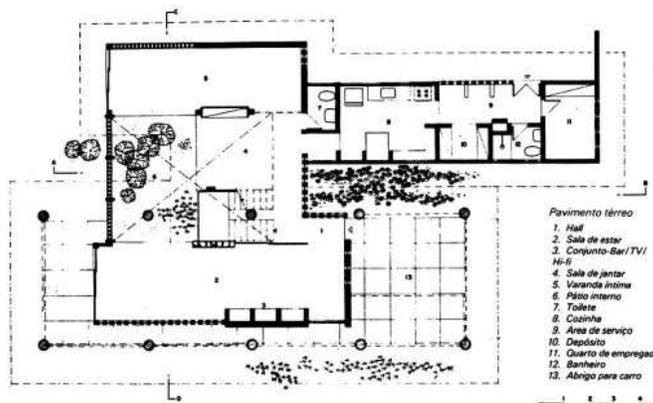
Planta baixa, residência do arquiteto, 1971. Fonte: GUERRA; RIBEIRO, 2006.
